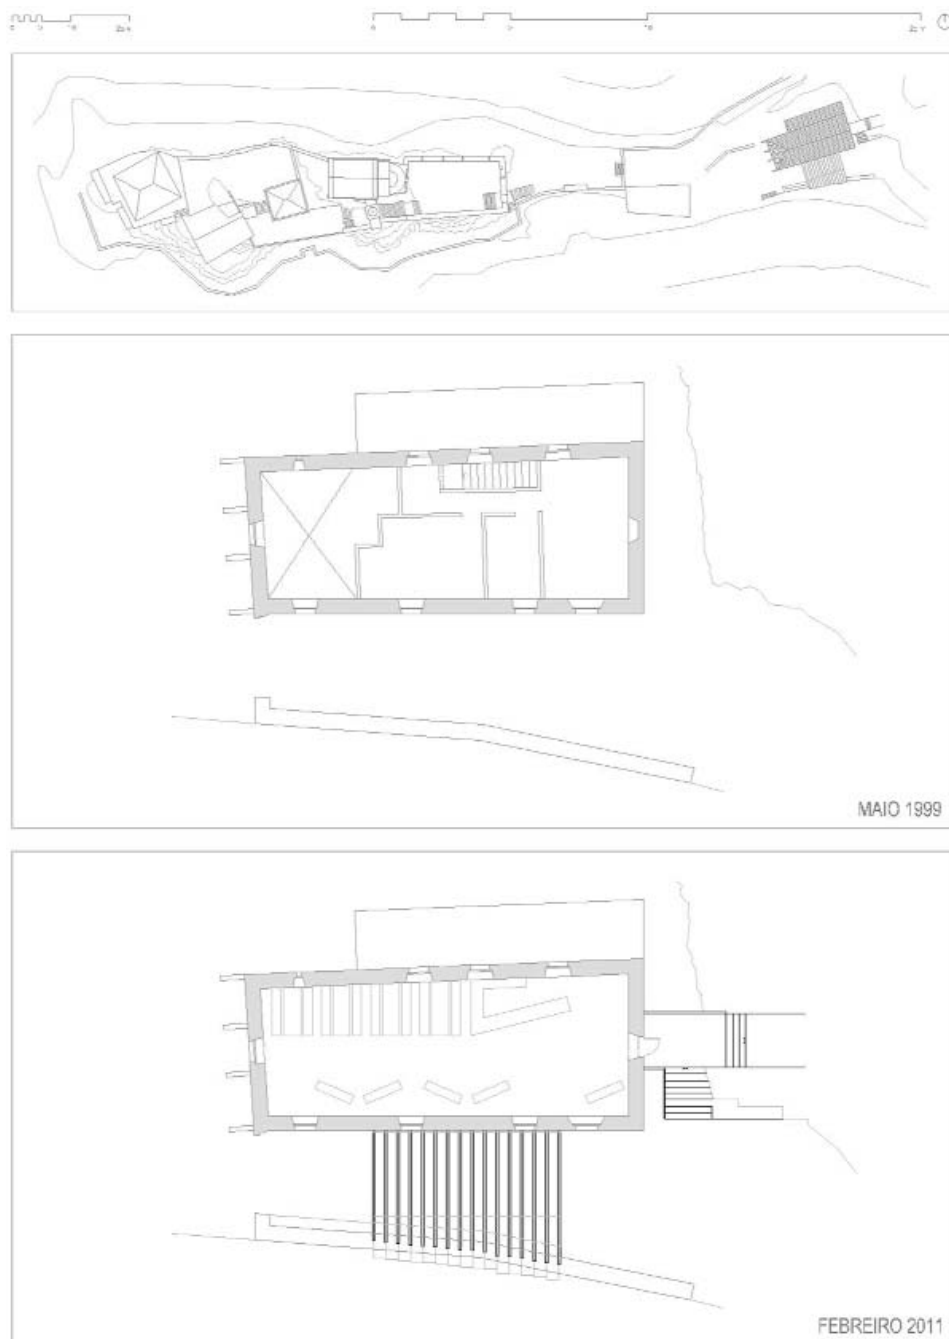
CAAVEIRO. Planta alta da Casa dos Guardeses (Pavillón de servizos e aula).
